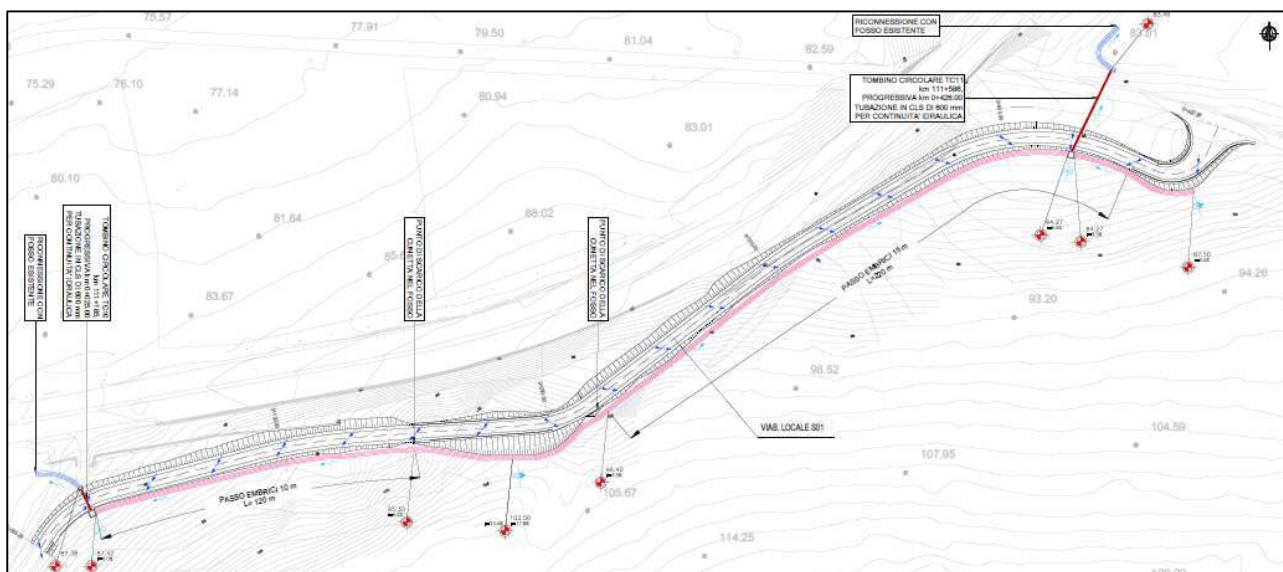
Stralcio planimetrico intervento S01-Risoluzione accesso C.N. al km 111+160
